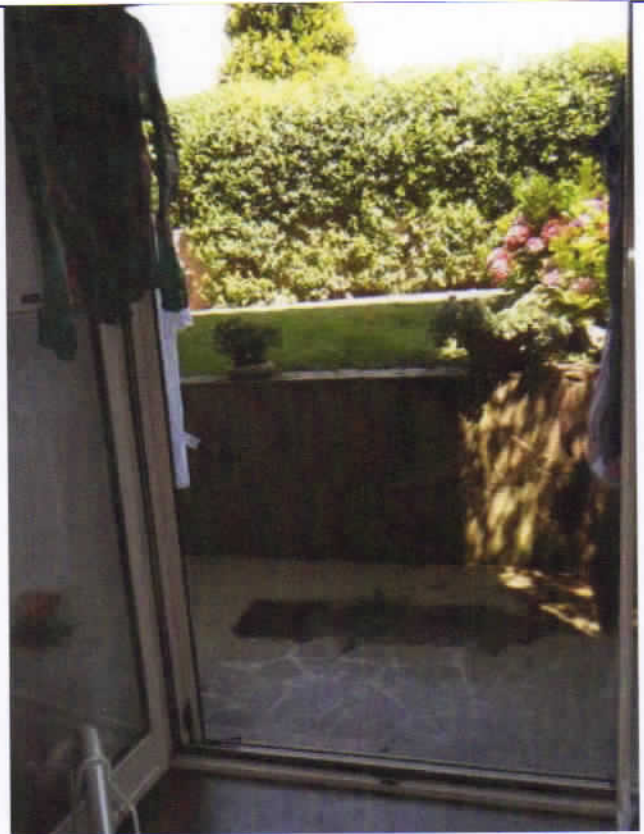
Porta finestra dalla lavanderia sullo spazio esterno
